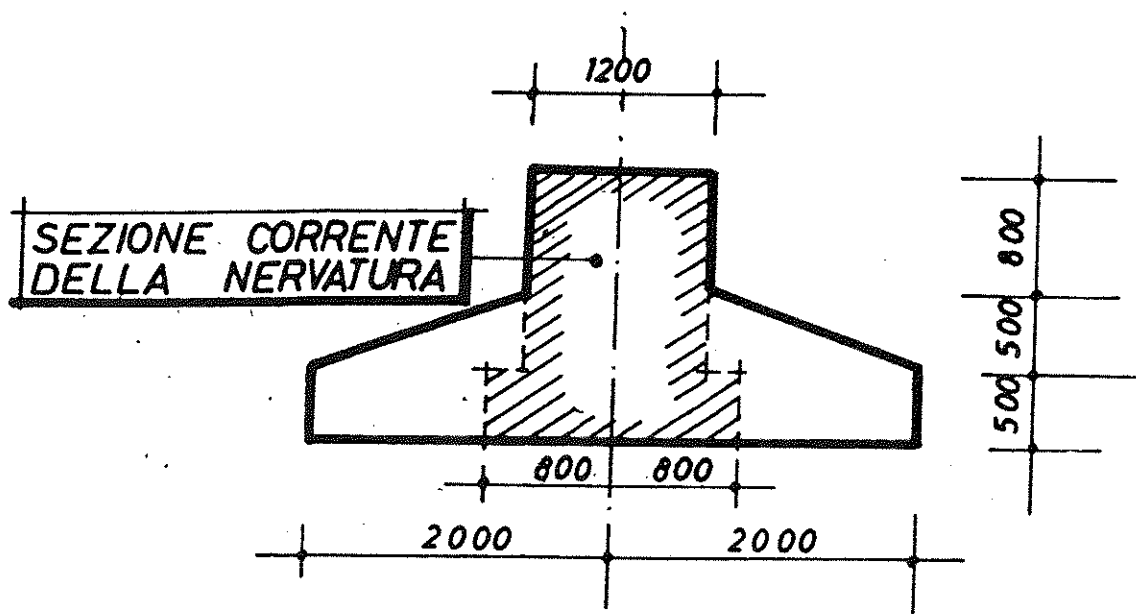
Trave di fondazione lato ospedale: sezione trasversale in corrispondenza dei pilastri intermedi
